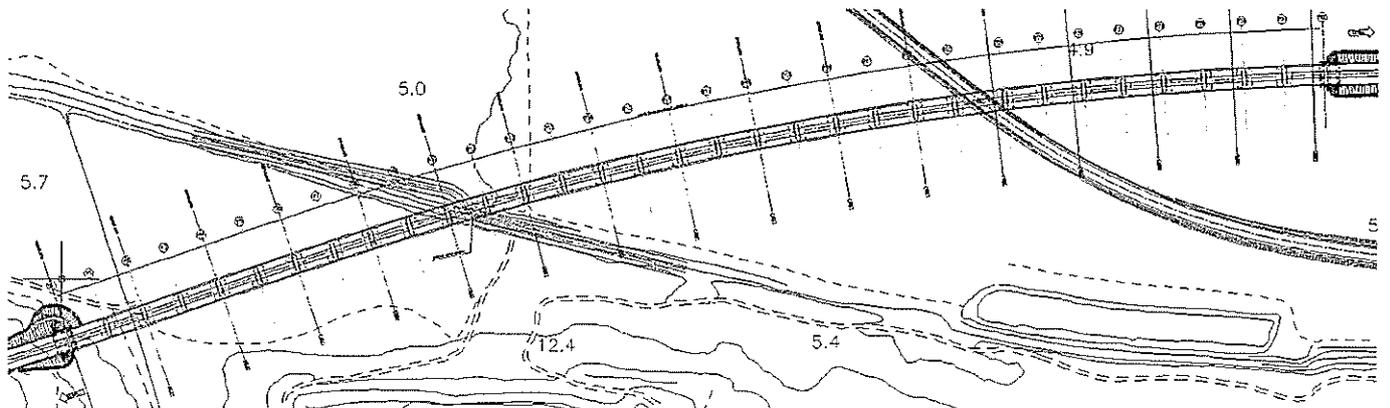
Viadotto Palude Capo d'Acqua: stralcio planimetrico
